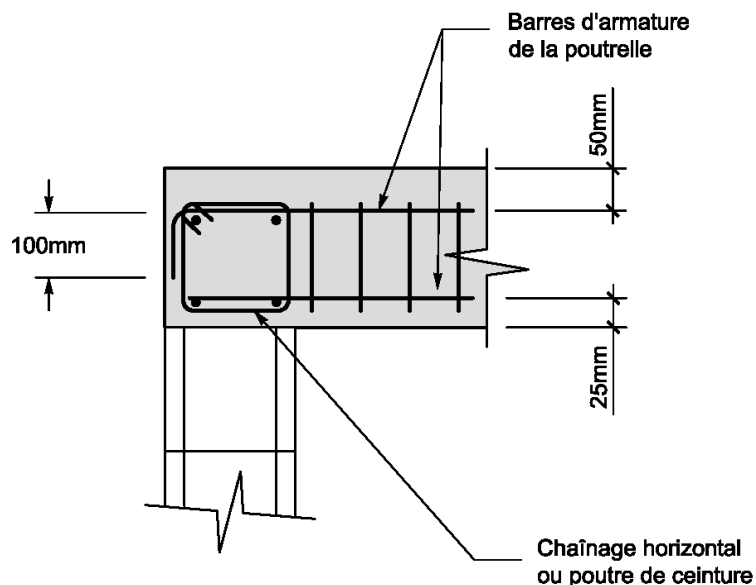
Connexion entre le chaînage horizontal et les poutrelles
